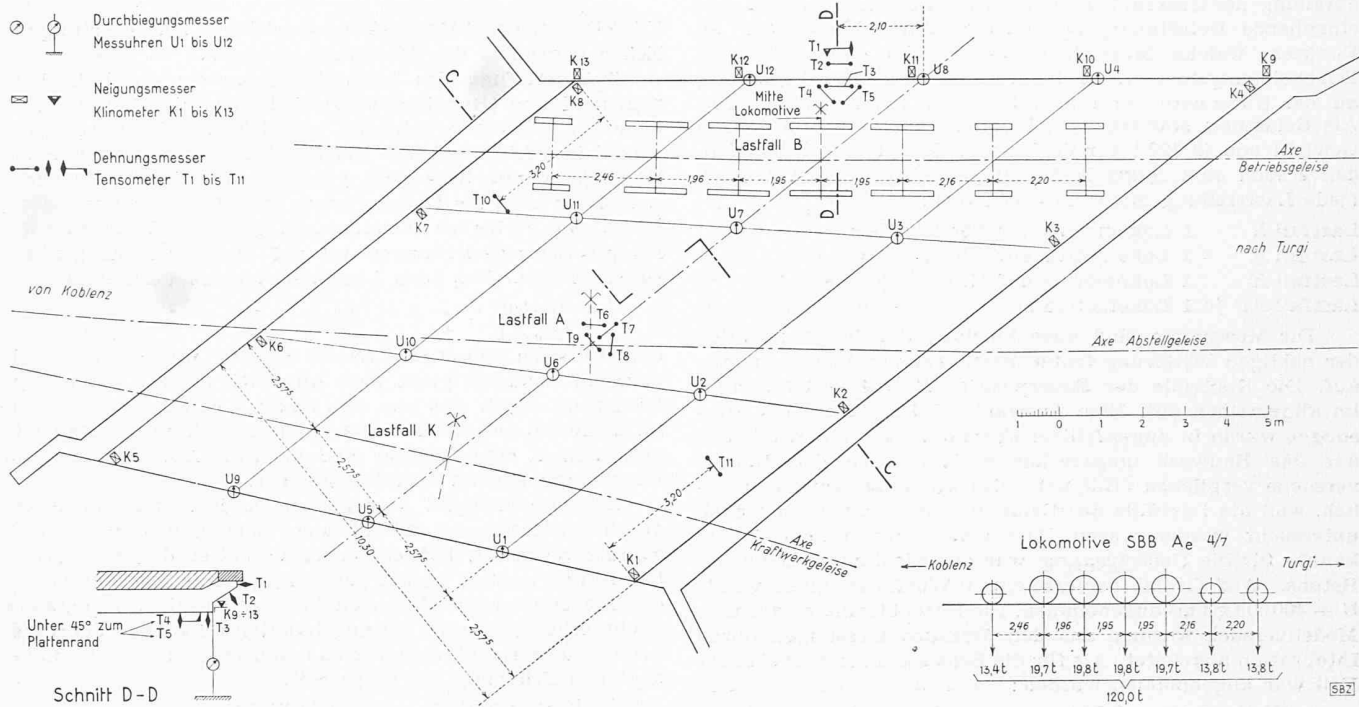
Belastungsprobe: Anordnung der Messinstrumente und der Lasten, Grundriss 1:175
